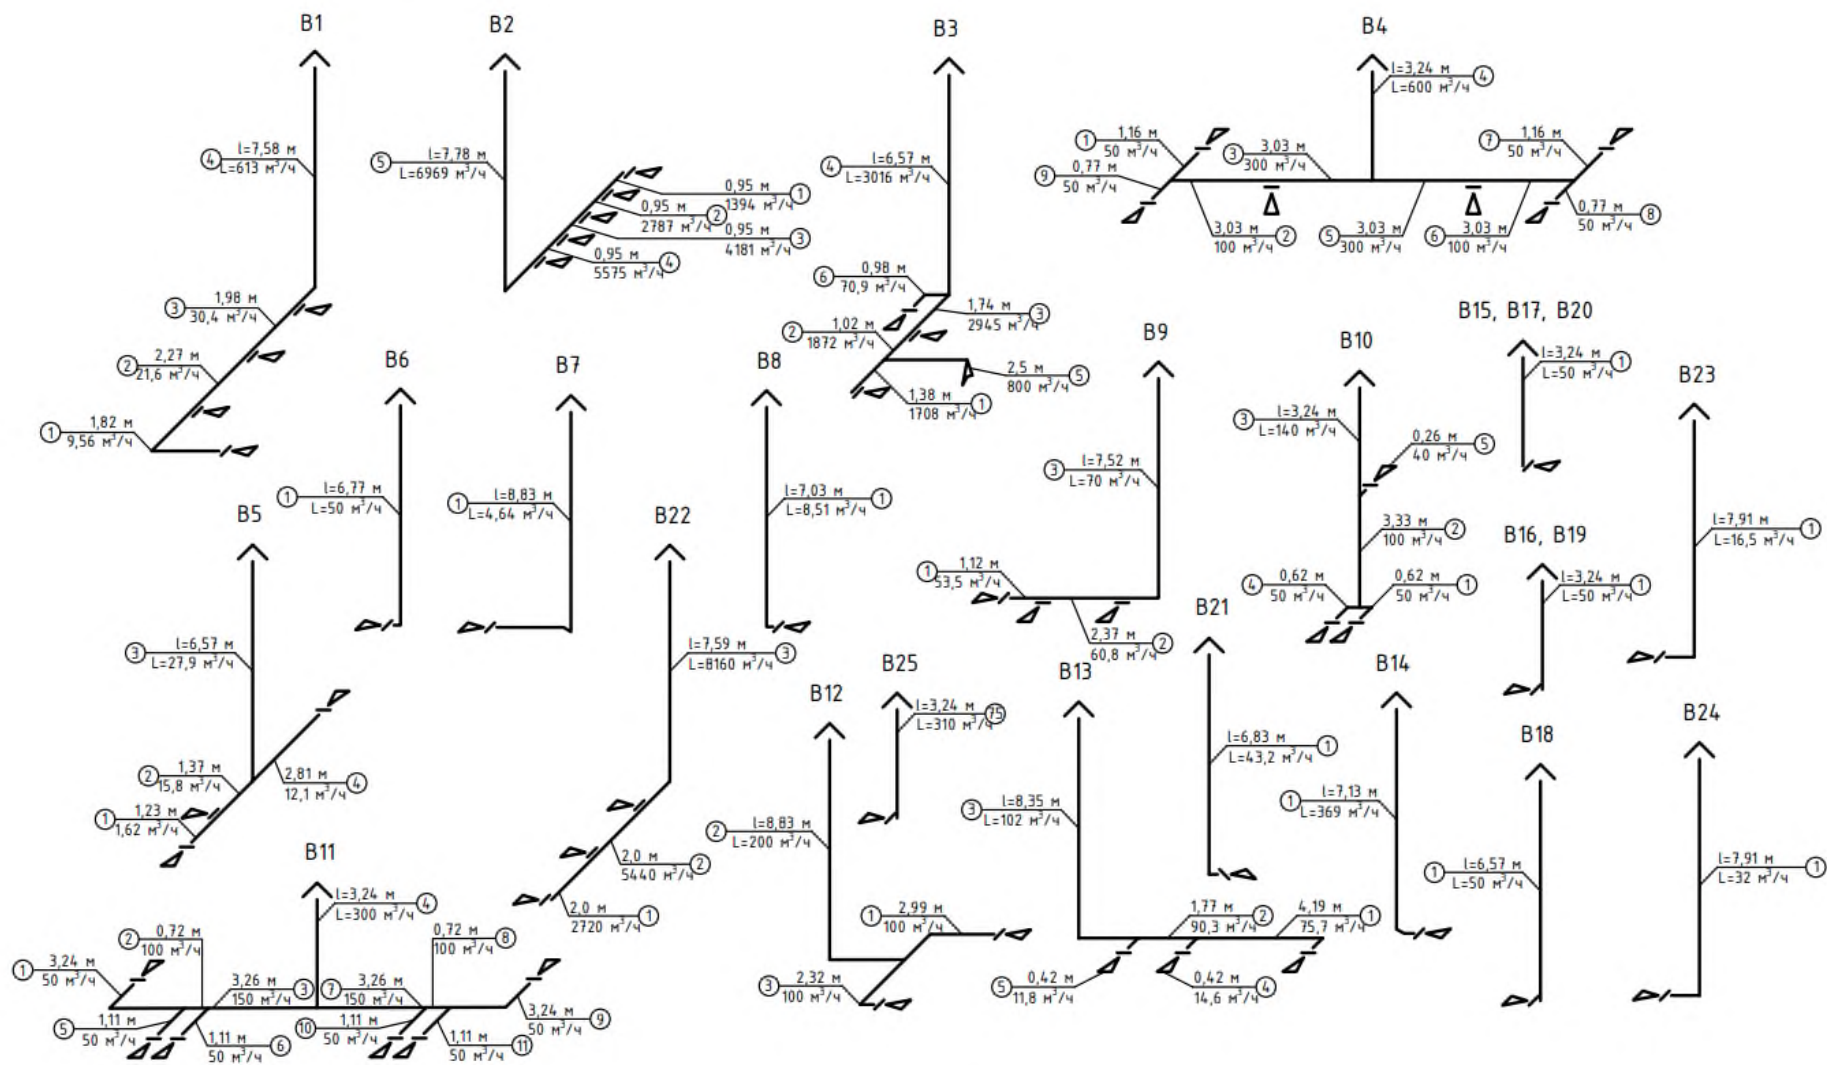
Расчетные схемы систем вытяжной вентиляции
